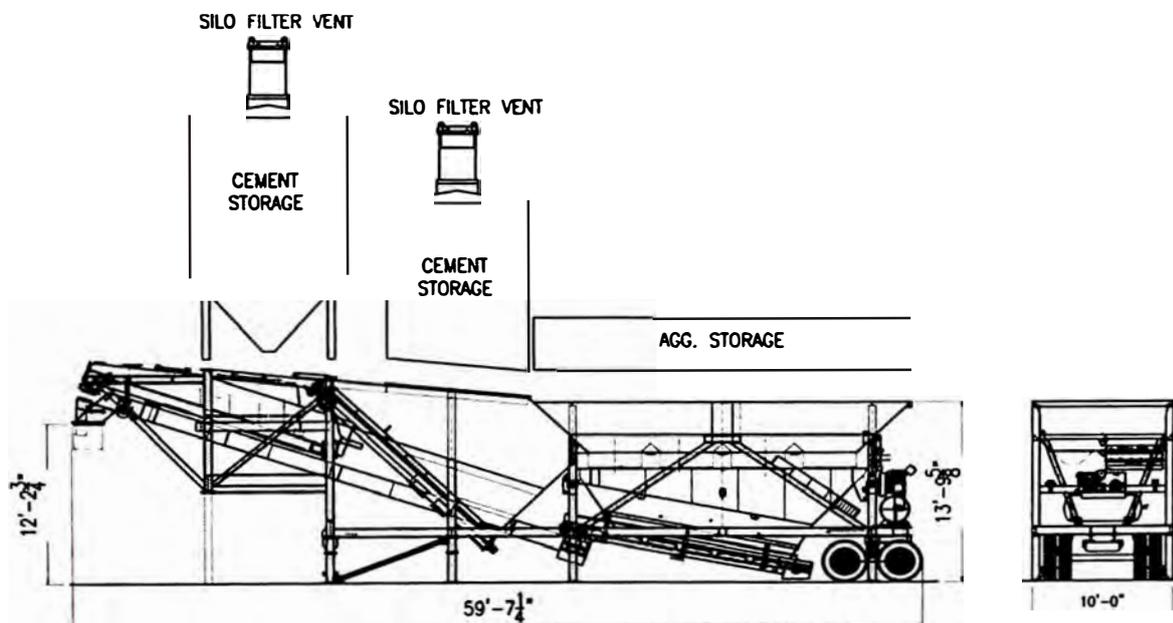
Disposición final de la planta (Fuente: CON-E-CO)
